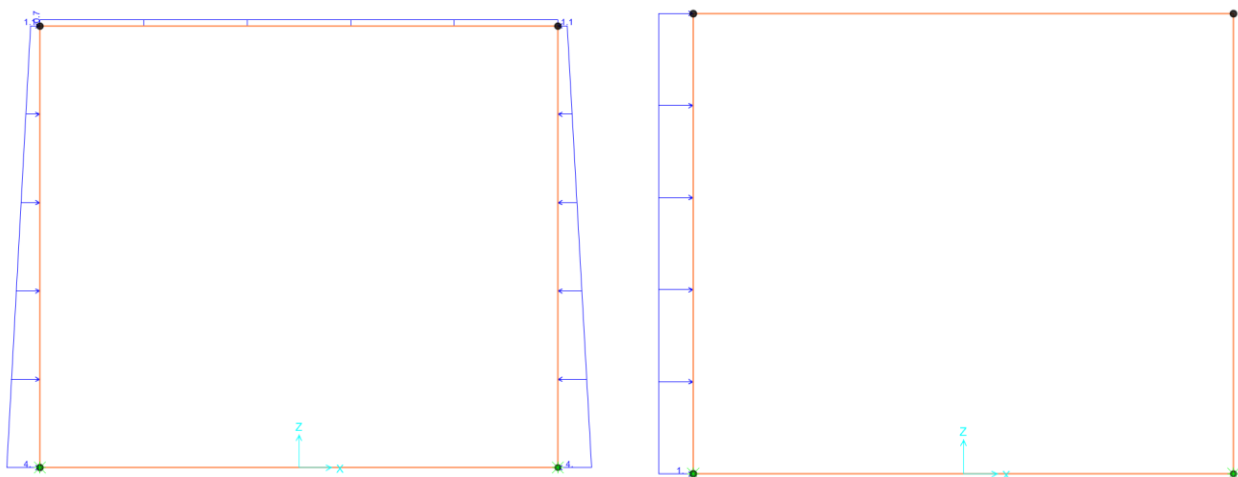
Peso permanente portato dalla pavimentazione stradale.
